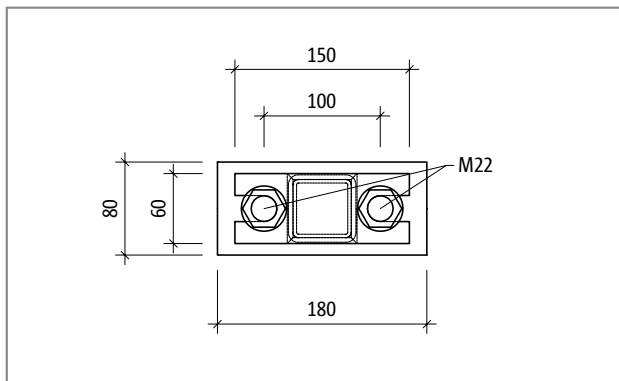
Schöck Isokorb® T type S-V-D16: Doorsnede
